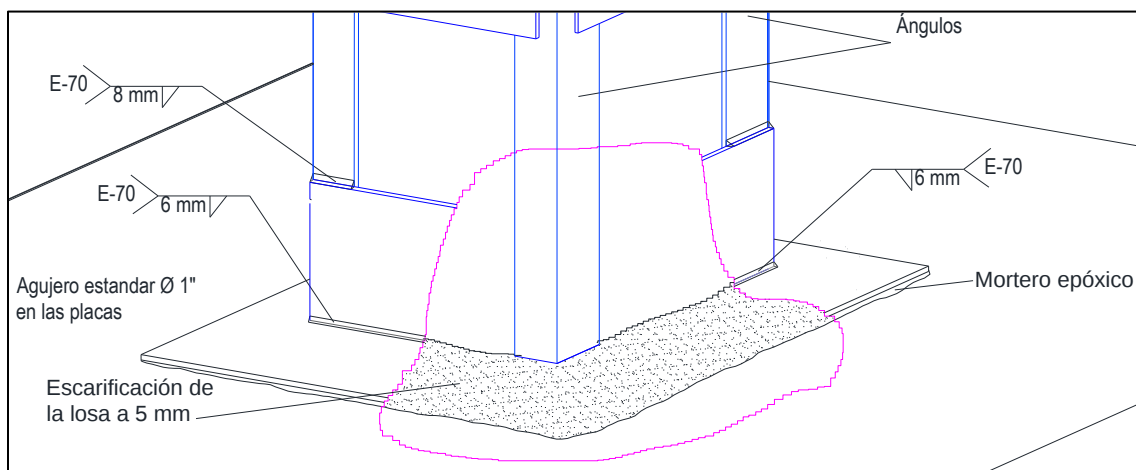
Detalles de la soldadura en la zona de colocación de las placas.
